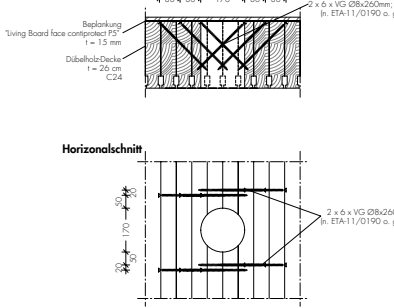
Schubanschluss Dachdeckenscheibe an Stahlbeton
